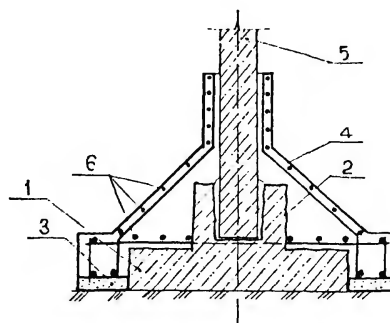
Устройство железобетонной рубашки с уширением площади подошвы
